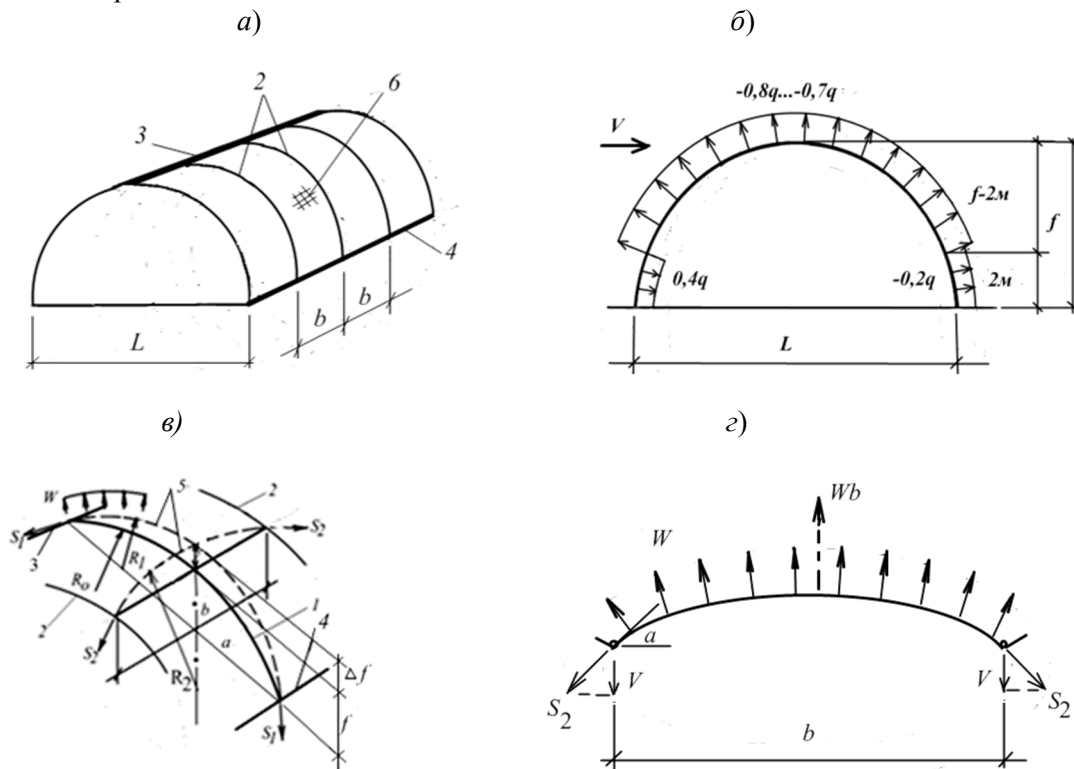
Схемы крепления плёнки (а), ветровой нагрузки на теплицу (б), усилий в деформированном ограждении теплицы (в), расчётная схема продольной нити (з): 1- арка; 2 – ветровой канат; 3,4 – коньковый и цокольный крепёжные элементы; 5 – деформированная кровля; 6 – плёночная кровля (\$q\$ – ветровое давление)
